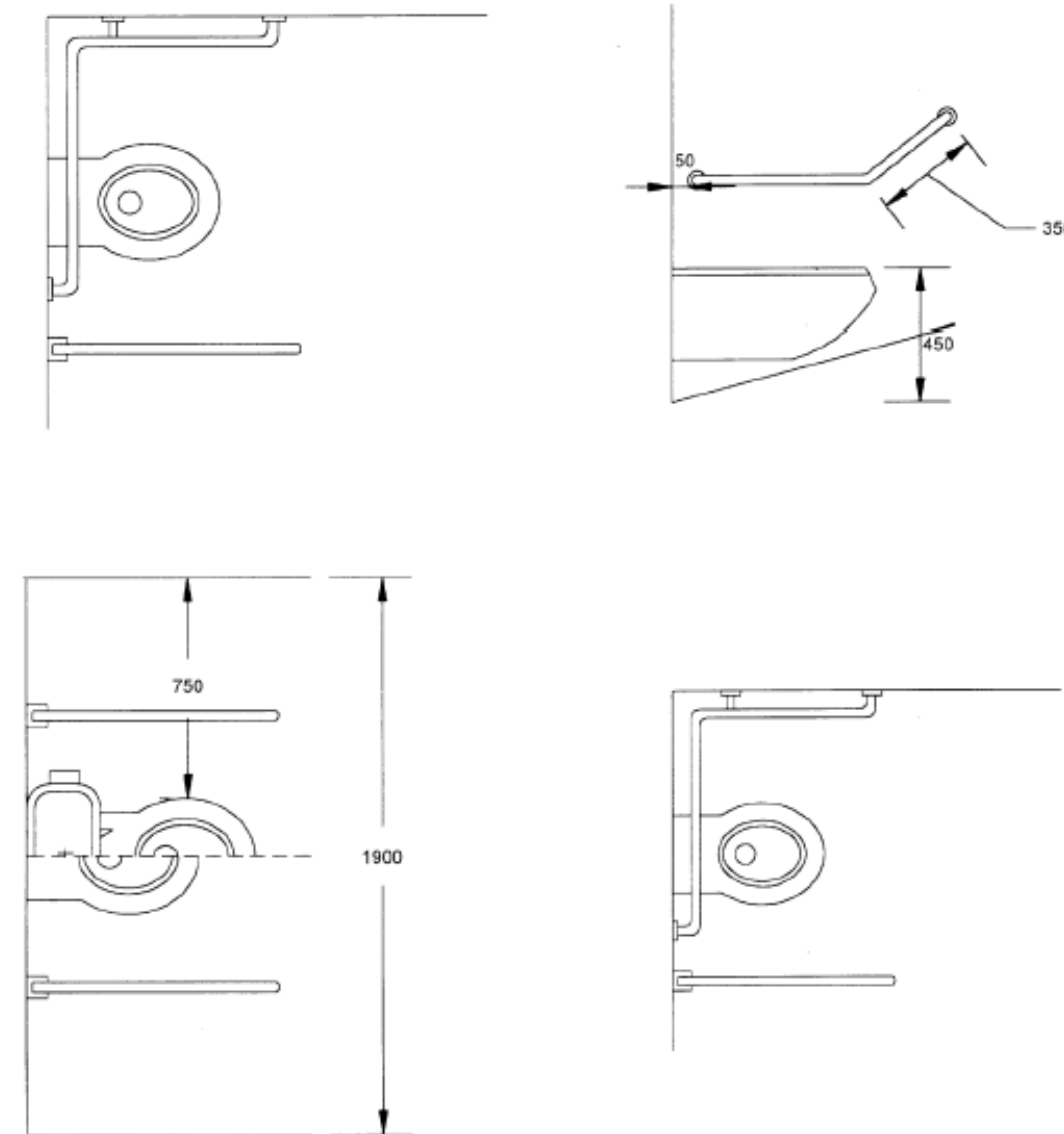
Barras de apoyo. Tipos. (Dimensiones en mm)
